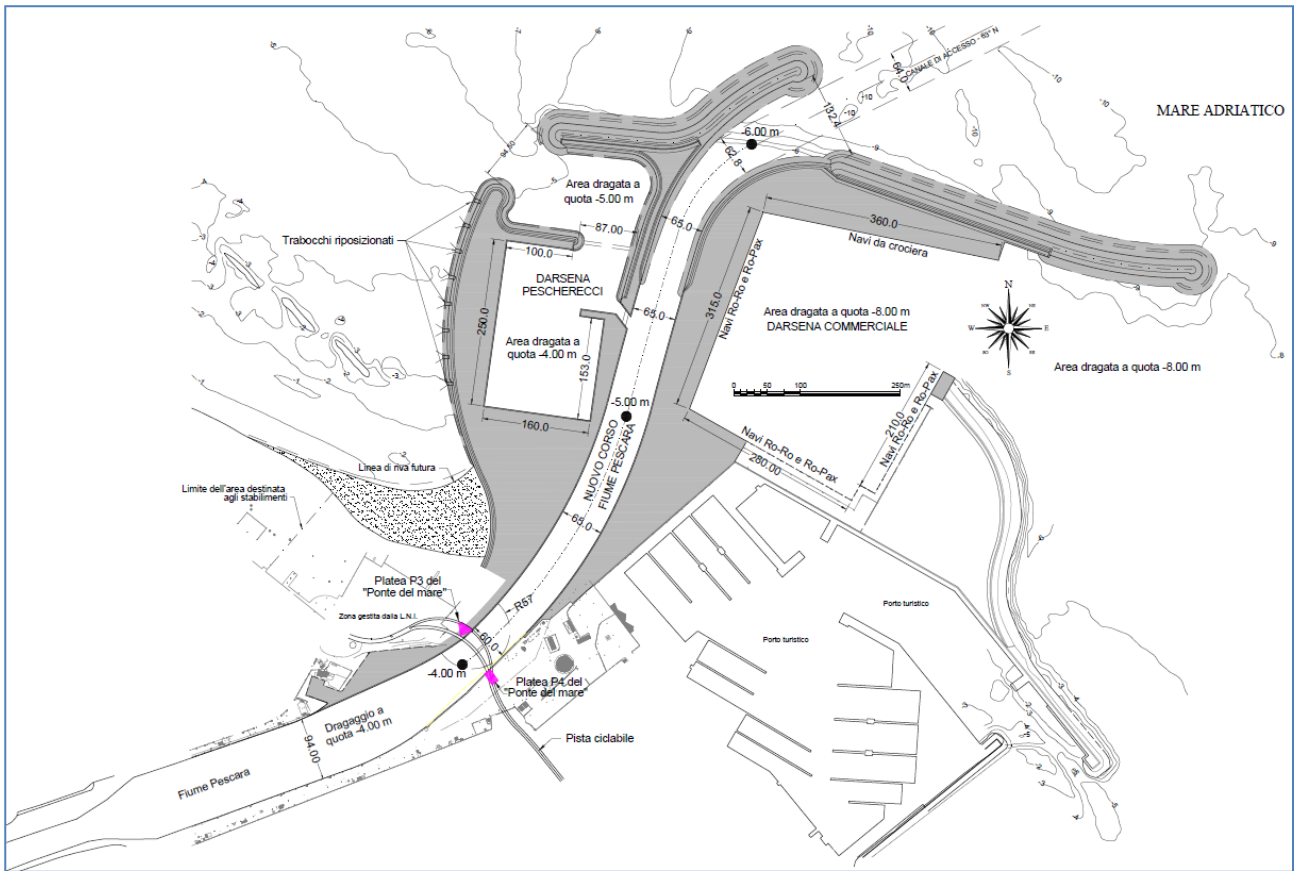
Deviazione del tratto terminale del fiume Pescara prevista dal PRP 2008 (planimetria generale e dettaglio in corrispondenza dell'intersezione del fiume con il Ponte del mare).
